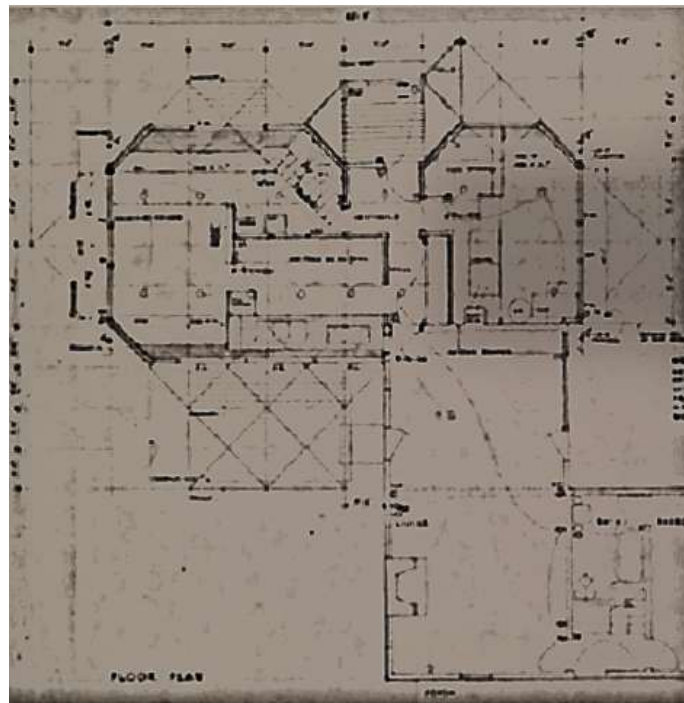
Detalle planta de la propuesta final de la adición de la casa Walworth Tyng.
